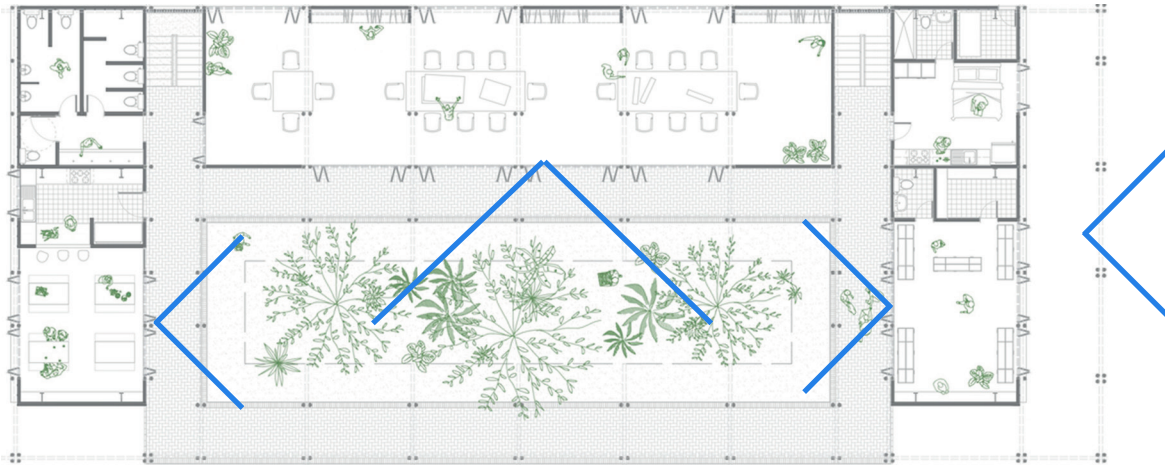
"Las Tejedoras" – Planta baja – Vistas
